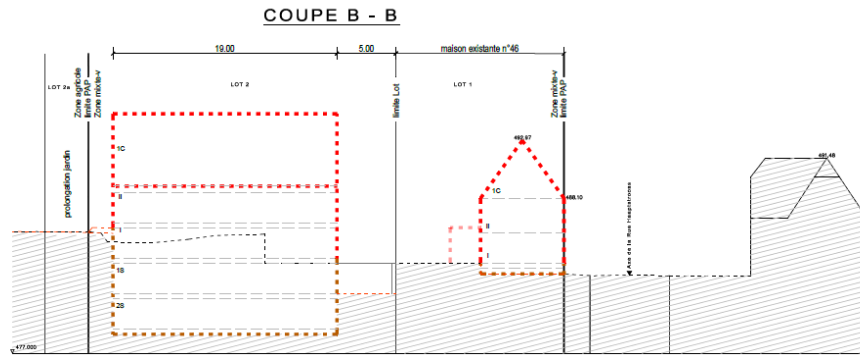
Coupe longitudinale des bâtiments (Source : BEST)
